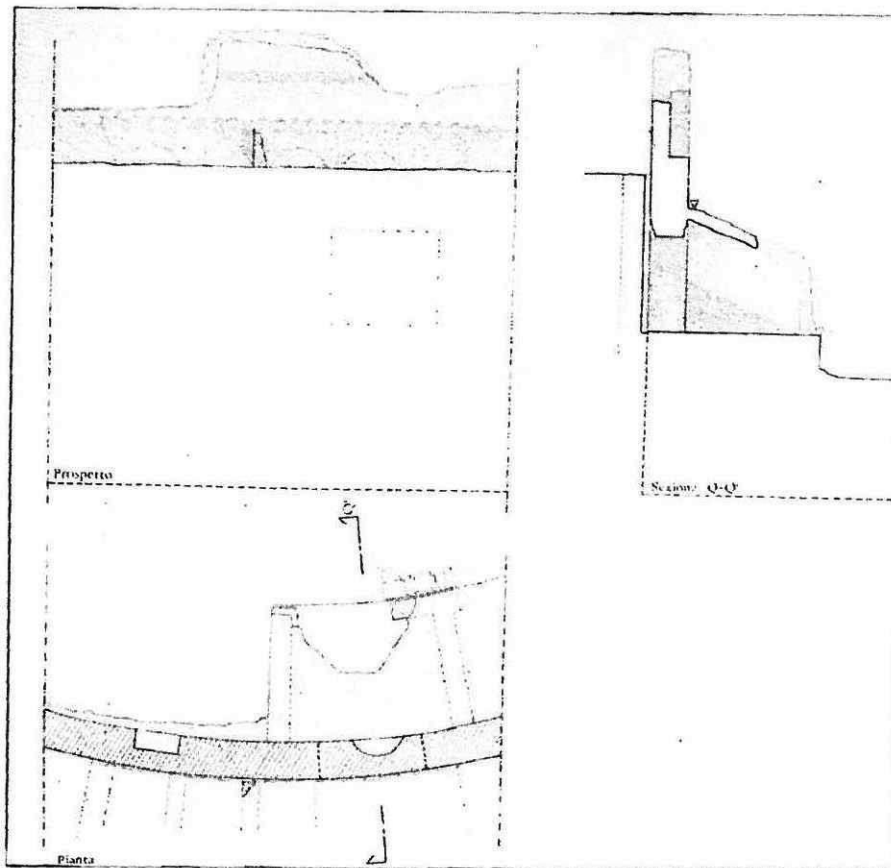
Pianta, prospetto e sezione dell'ambiente alla sinistra della cavea.
